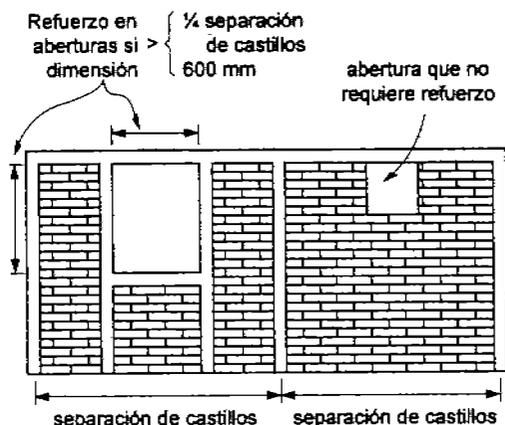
REQUISITOS PARA MAMPOSTERÍA CONFINADA, CON REFUERZO EN EL PERÍMETRO DE ABERTURAS
